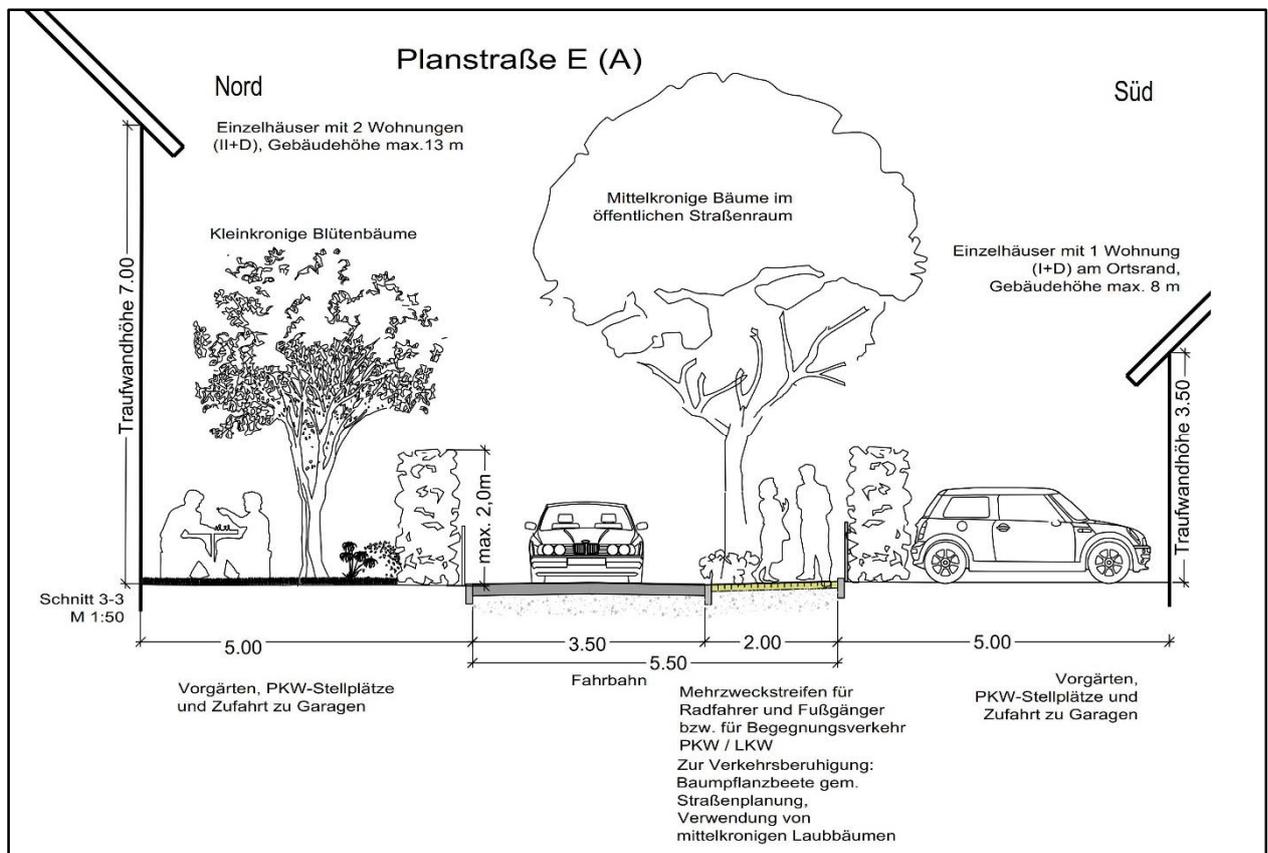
Straßenquerschnitt 5,5 m (Planstraßen E und A)
